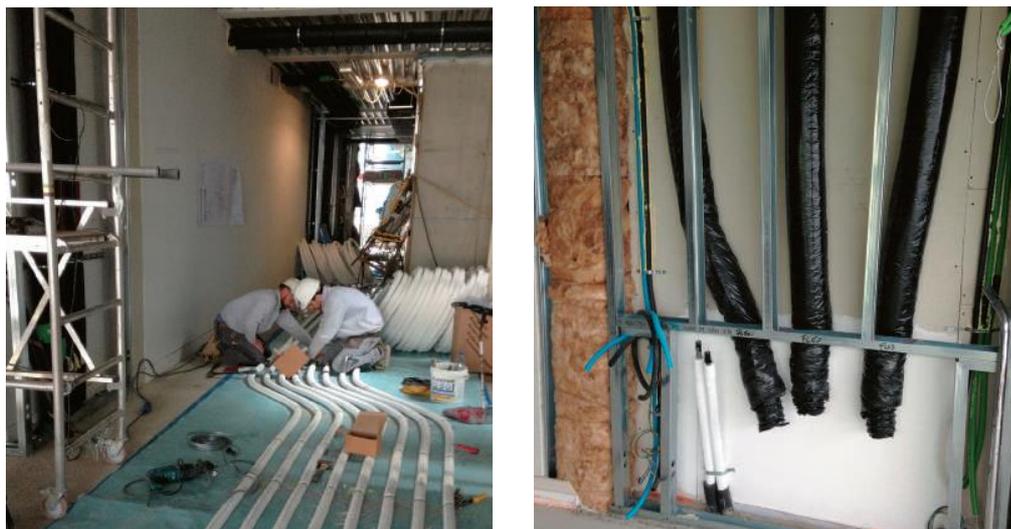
Dettaglio installativo delle tubazioni al piano
